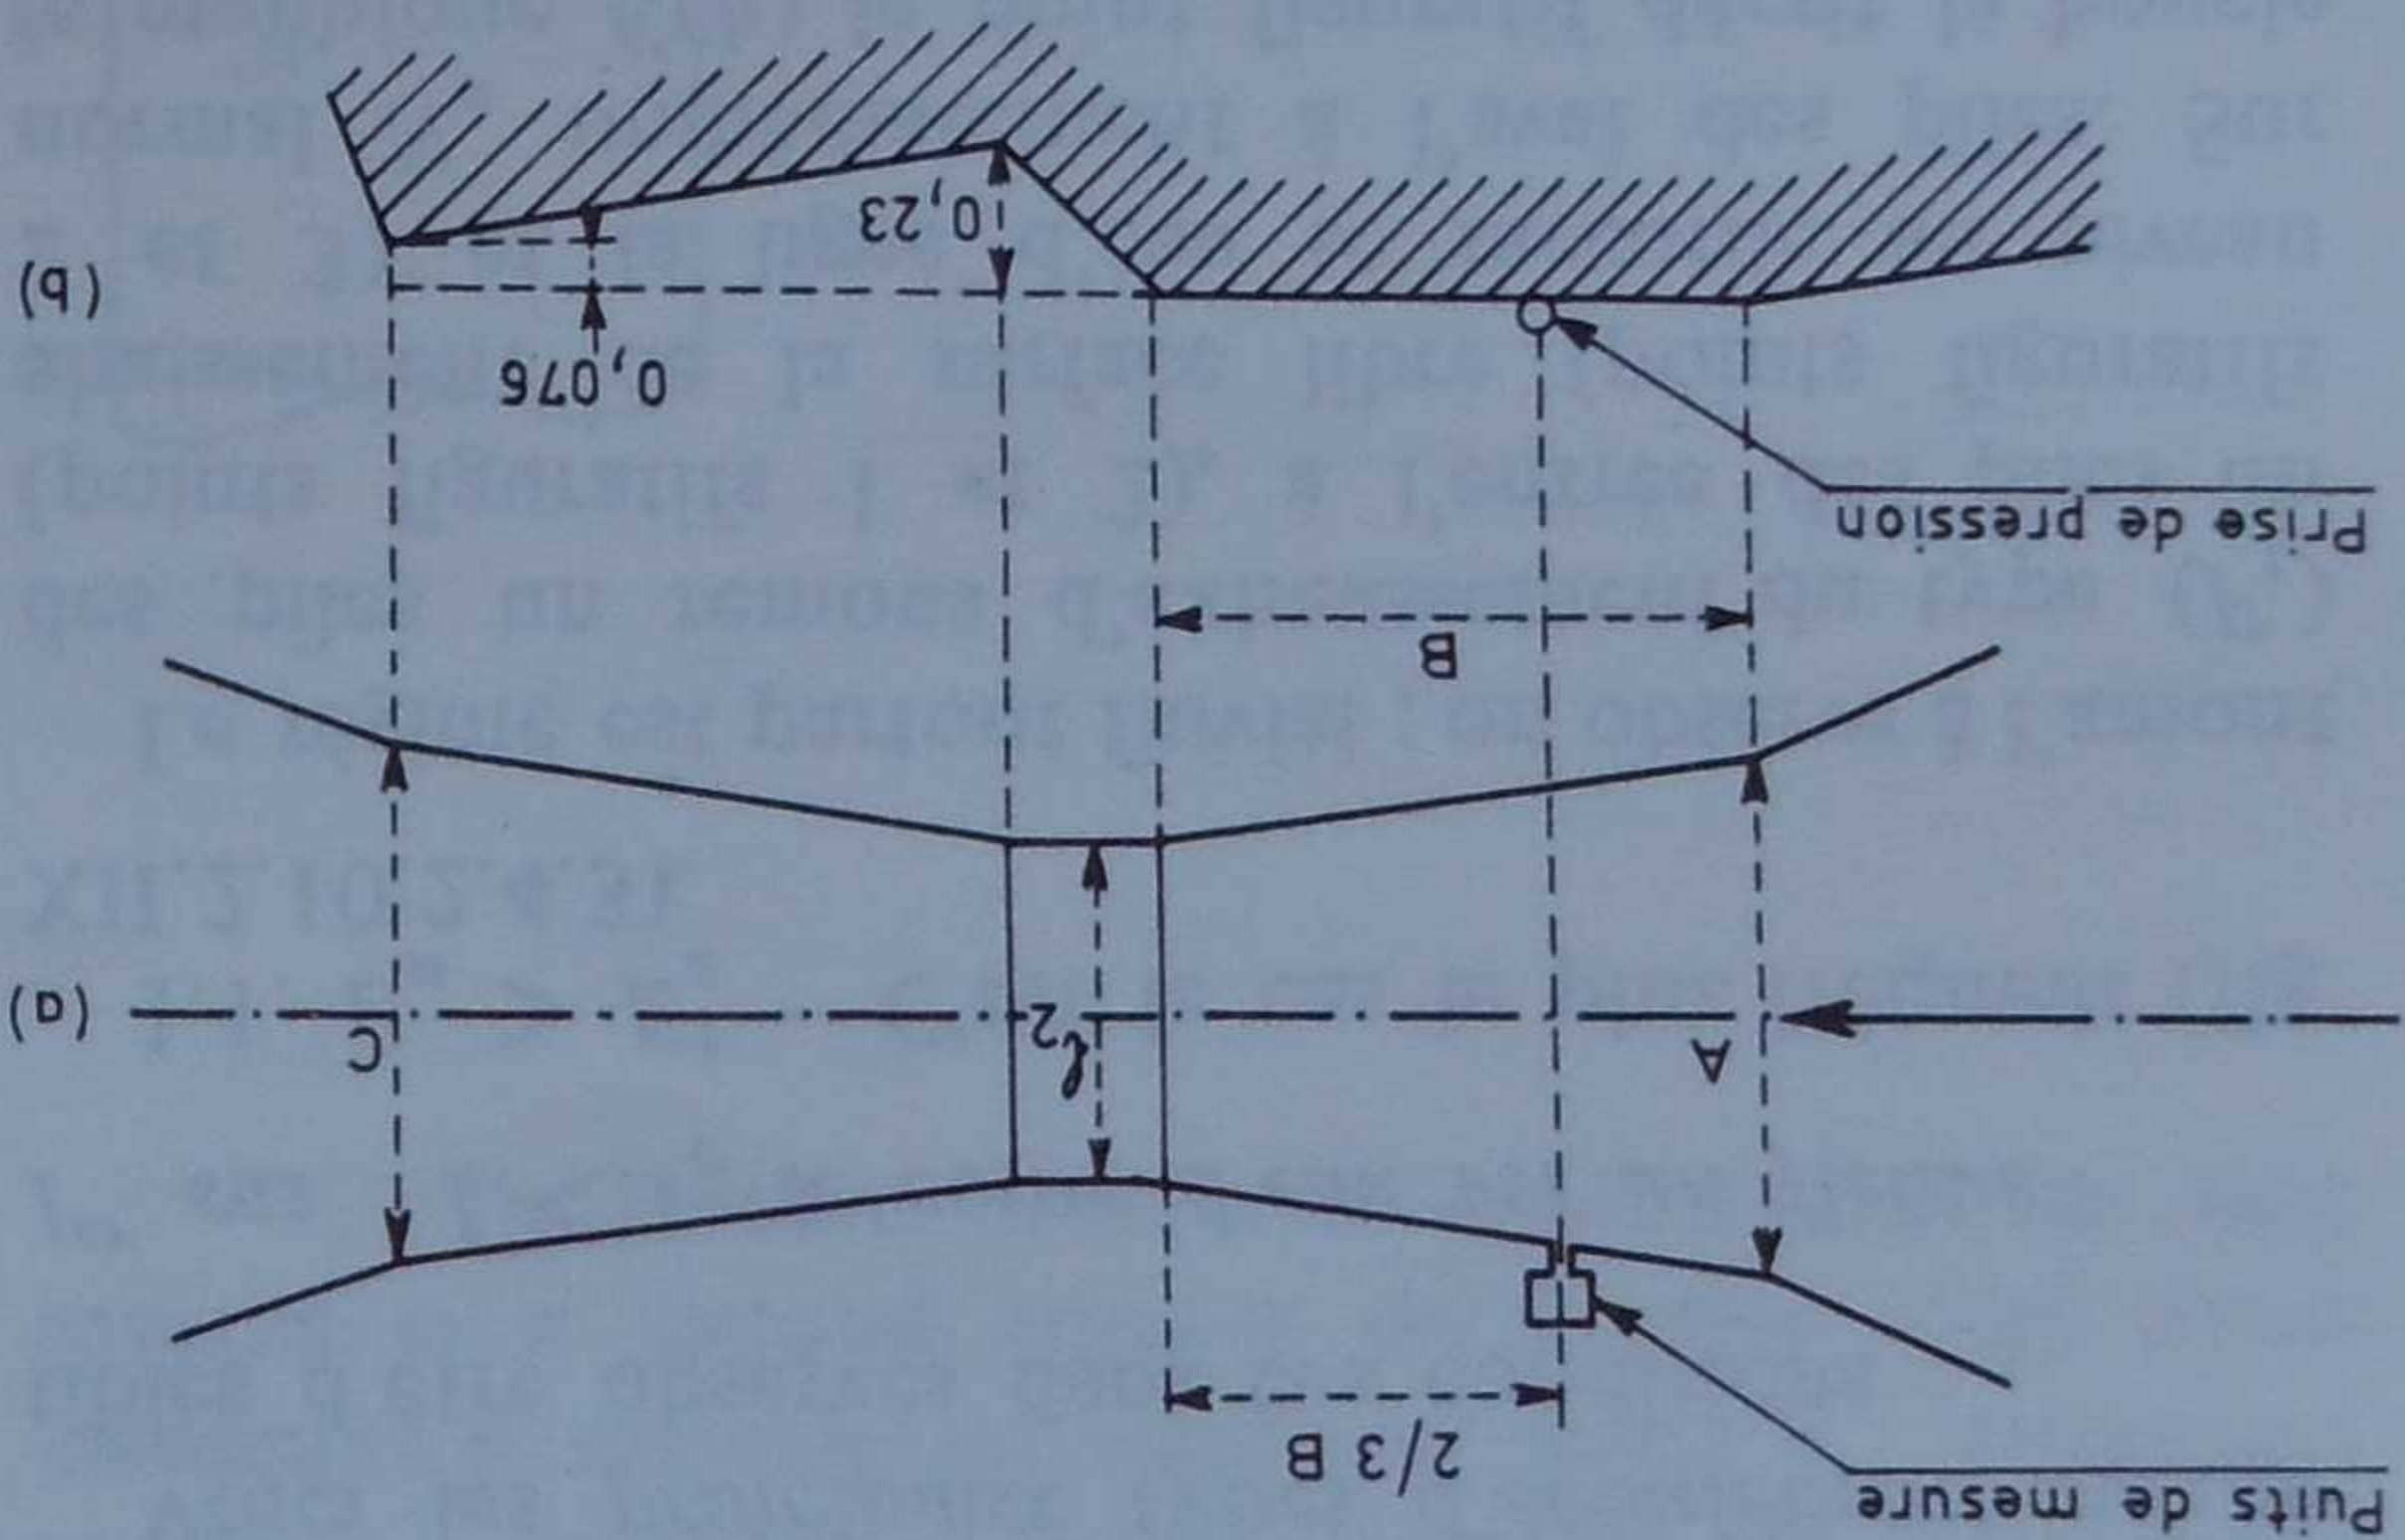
Dimensions usuelles d'un Parshall ; (a) : Vue en plan ; (b) : Profil longitudinal du radier
